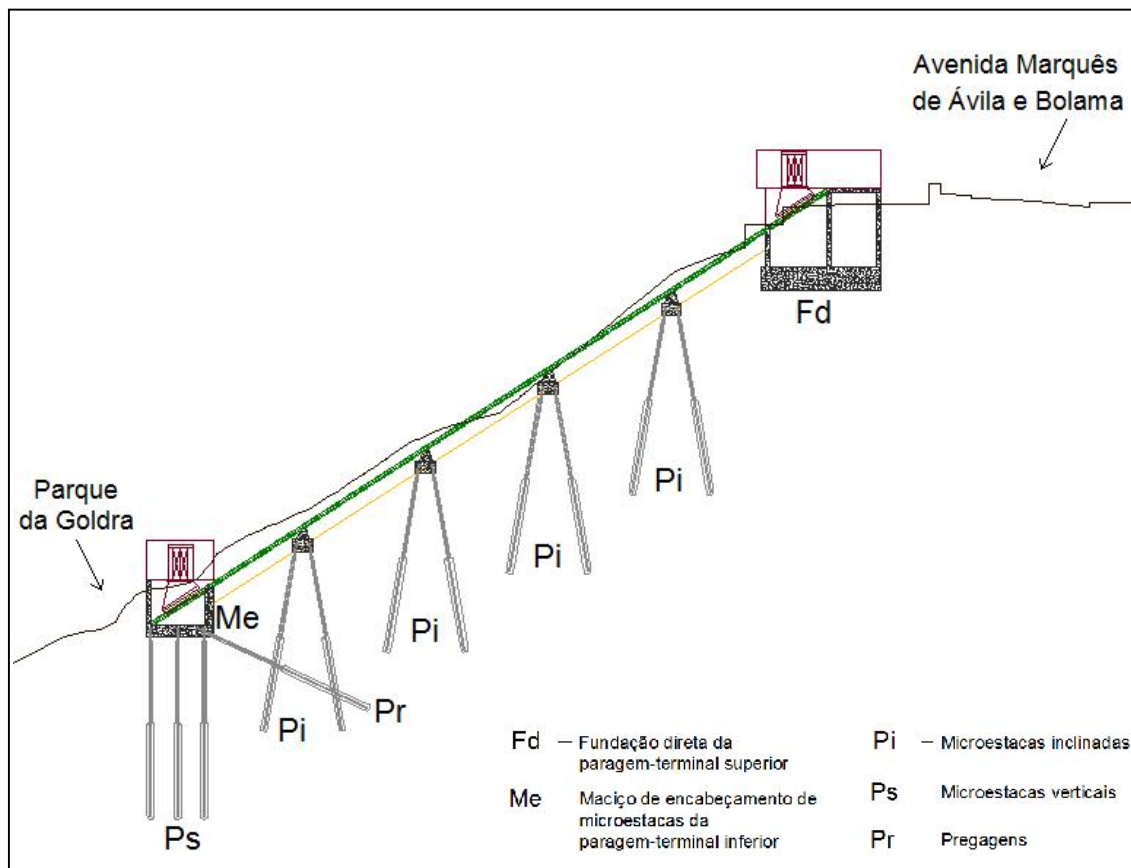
Principais elementos estruturais em corte segundo o eixo do tabuleiro do elevador da Goldra (a partir de Ferreira e Venâncio, 2010).
